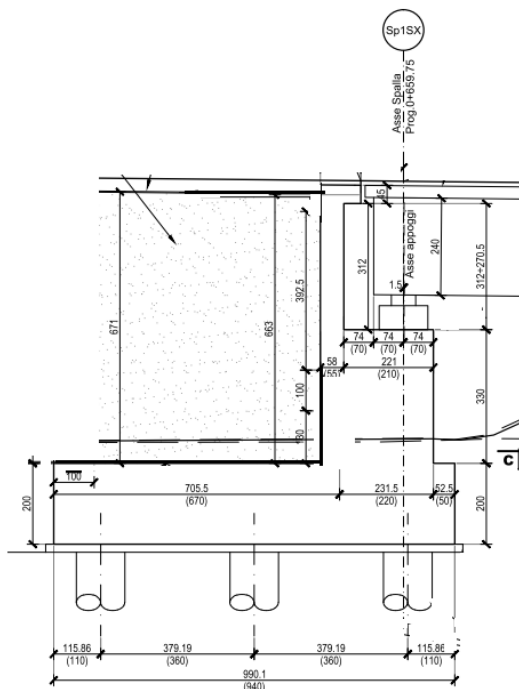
Sezione trasversale spalle SP1 ed SP2
